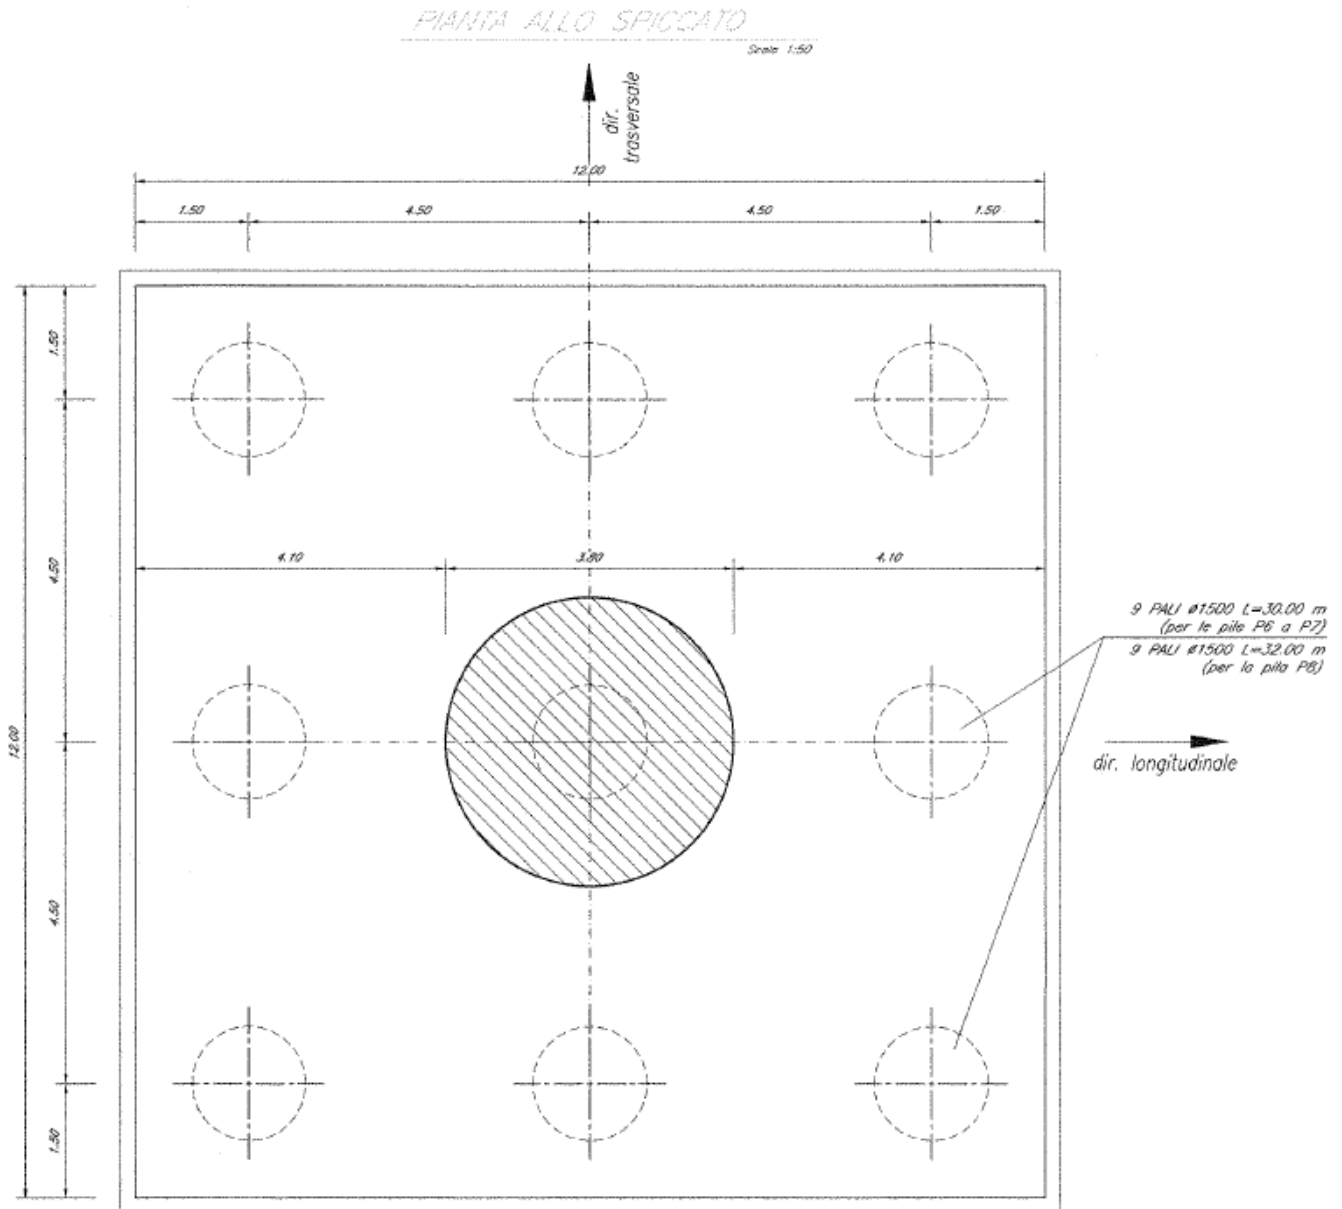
Plinto di fondazione e pali, vista in pianta - Sezione del fusto pila [m]
